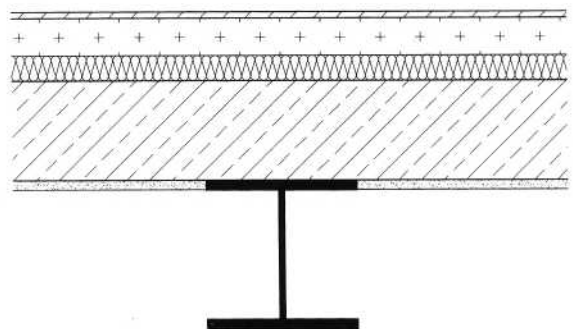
Konstruktionsaufbauten Wand und Decke für Holz- und Massivbauten
